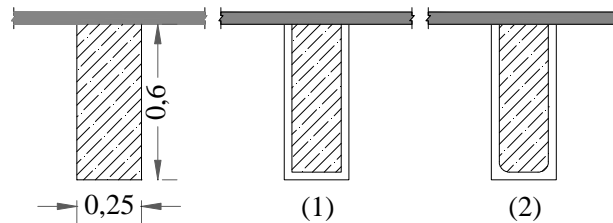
Secciones residuales ante la acción del fuego para la viga V1. Las Medidas están dadas en Metros
